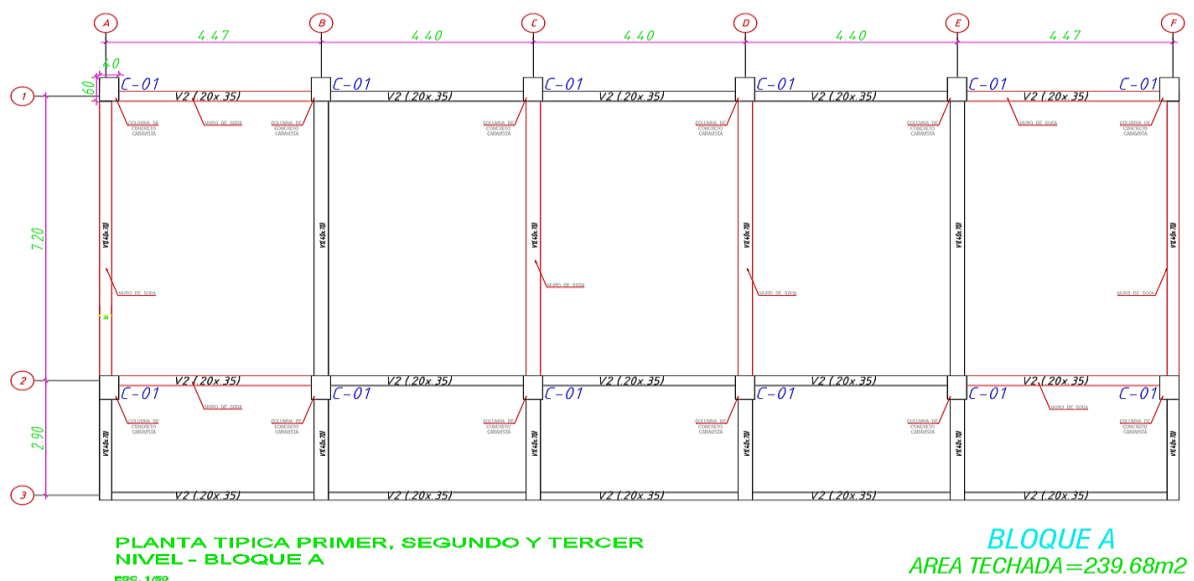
Planta típica de un edificio de 3 niveles destinado a aulas de un pabellón.
